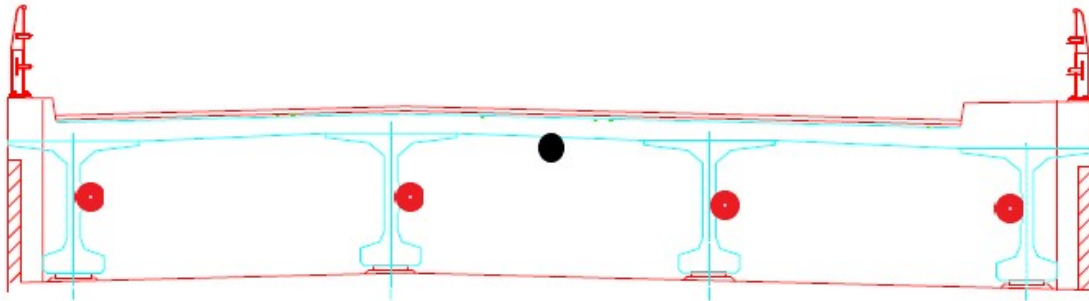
Vista corte a L/4 instalación de sensores
